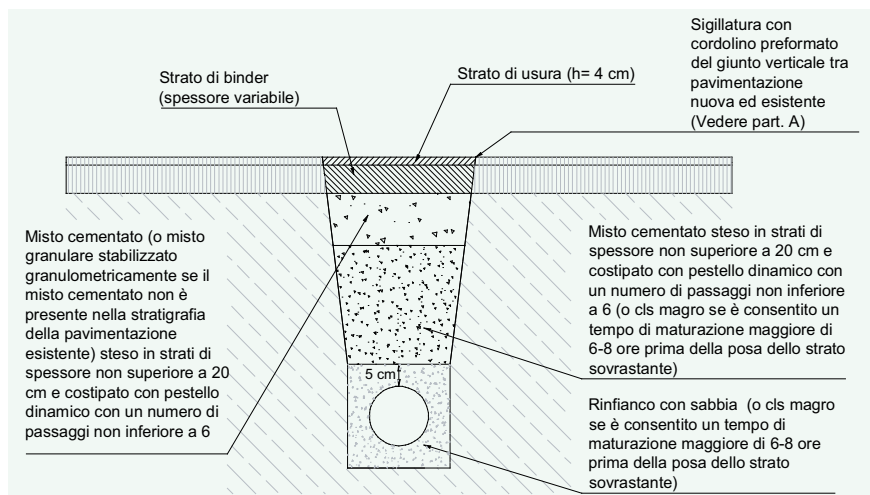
Sezione tipica in sede stradale (caso di pavimentazione in normali condizioni)
